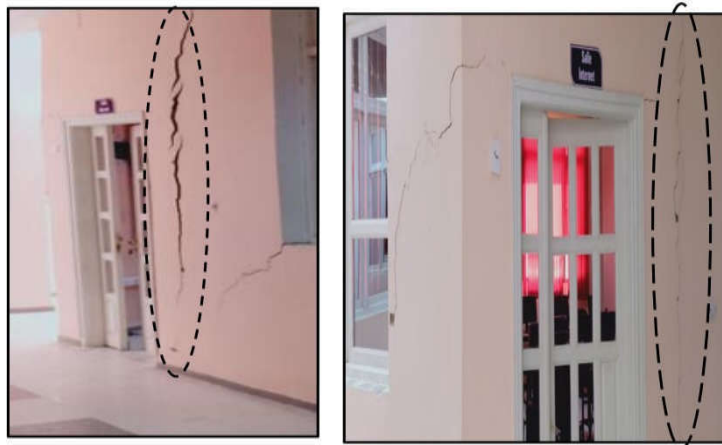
Fissure verticale au niveau d'un mur en brique (Longues lézardes).
